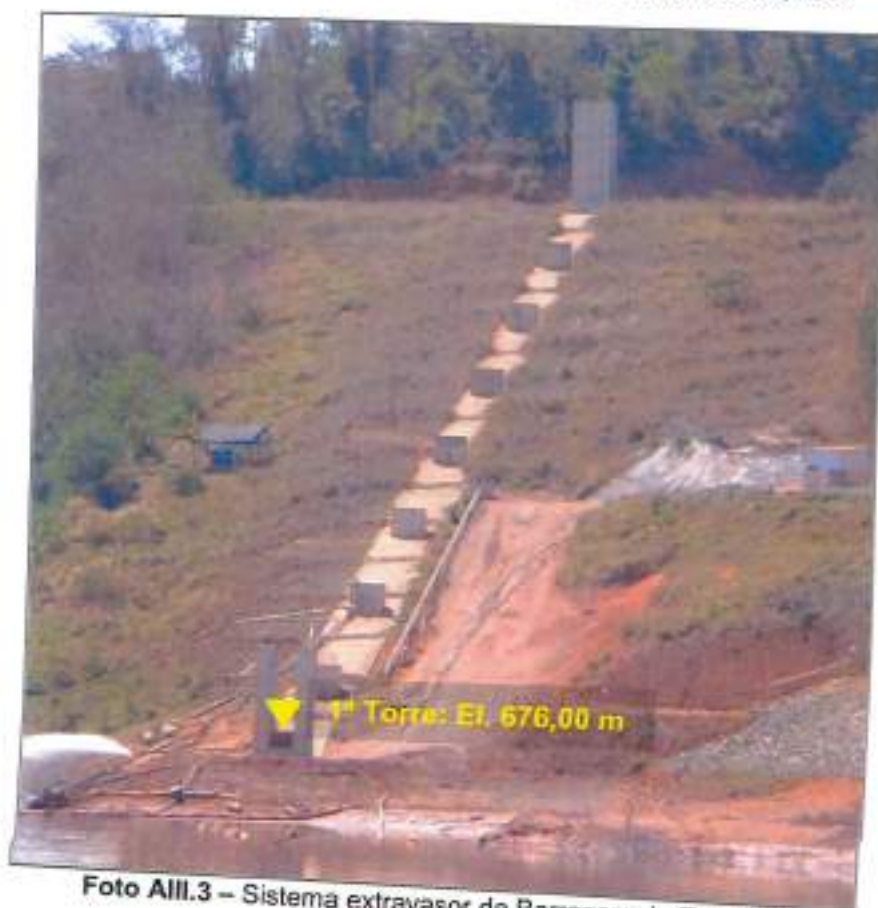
Sistema extravasor da Barragem de Rejeitos.
